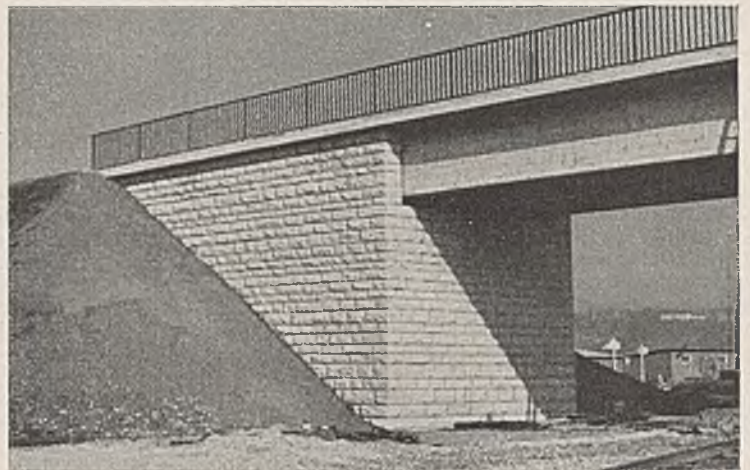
Gerade Brücke mit Eisenbetonplattenüberbau und mit Widerlagern mit Parallelfügeln.
